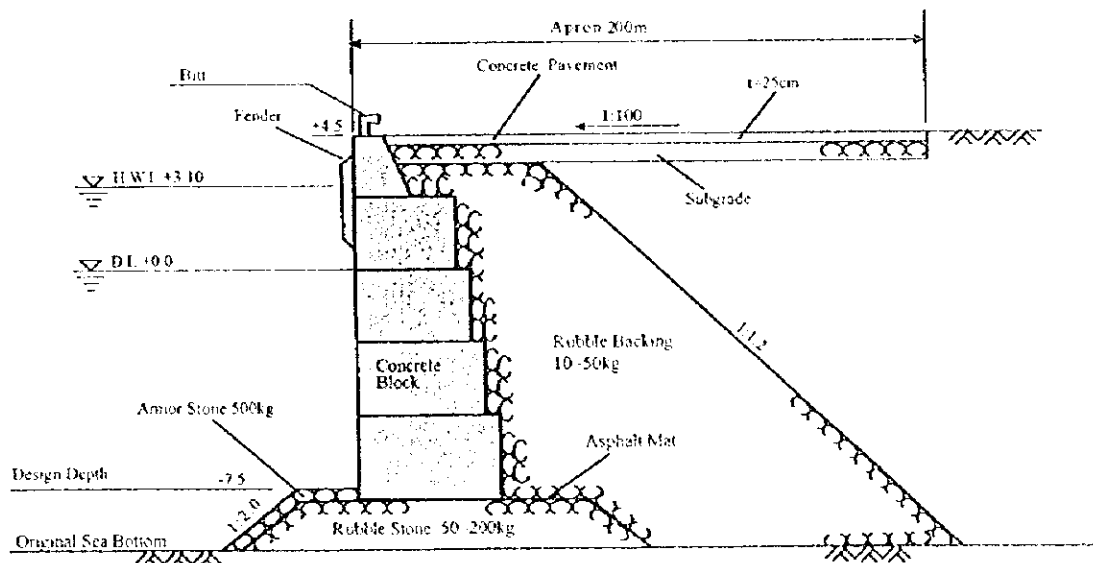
Atracadero de Pasajeros del Tipo Bloque de Hormigón (-7.5m)
